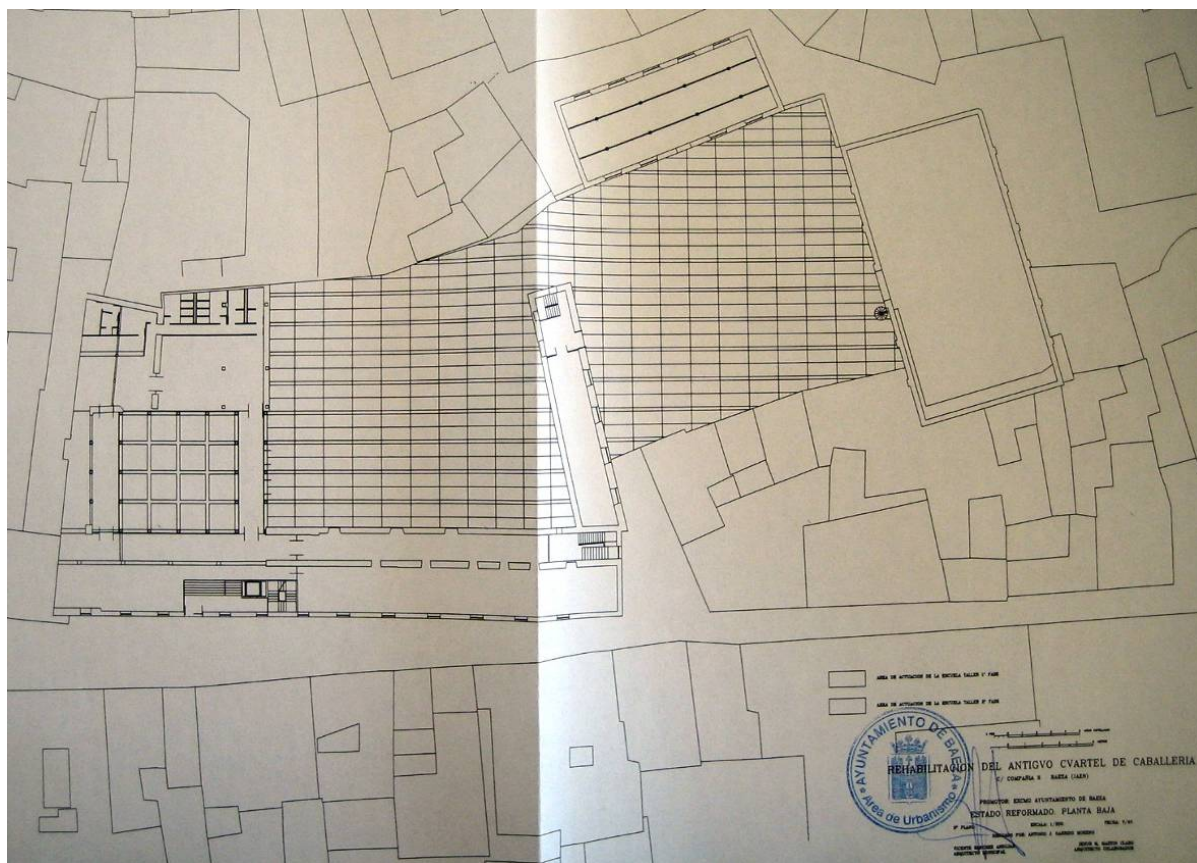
Planta baja. Estado reformado. Conjunto de edificaciones.
